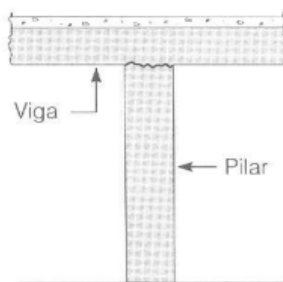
Manifestações típicas de fissuras em pilares.
